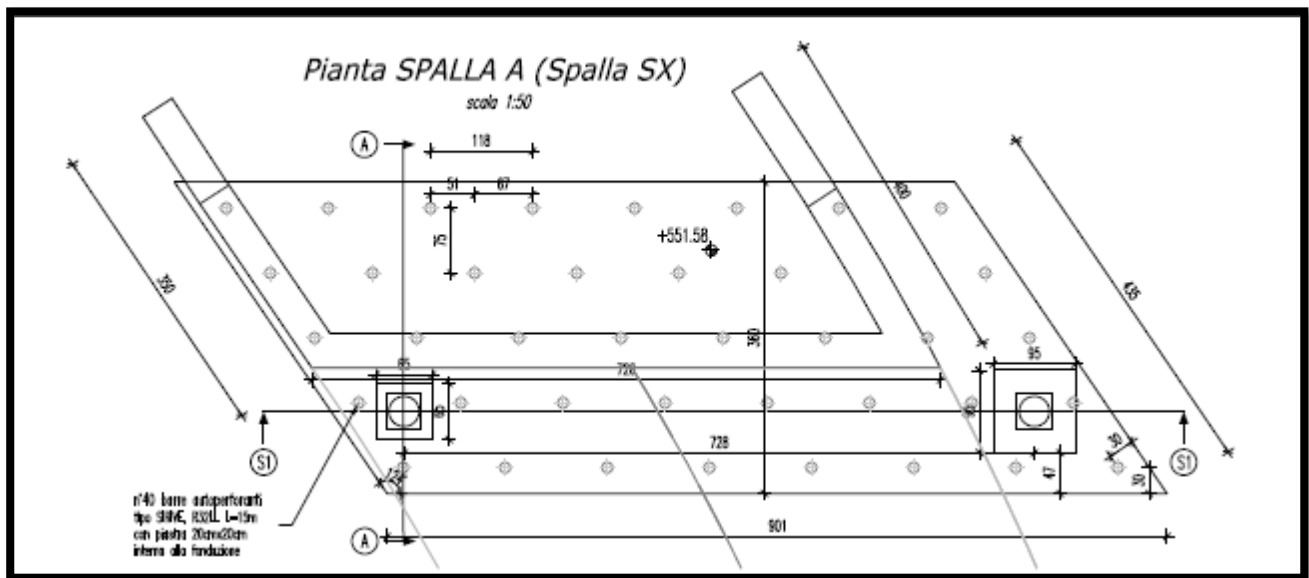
pianta della spalla A (spalla sx)
